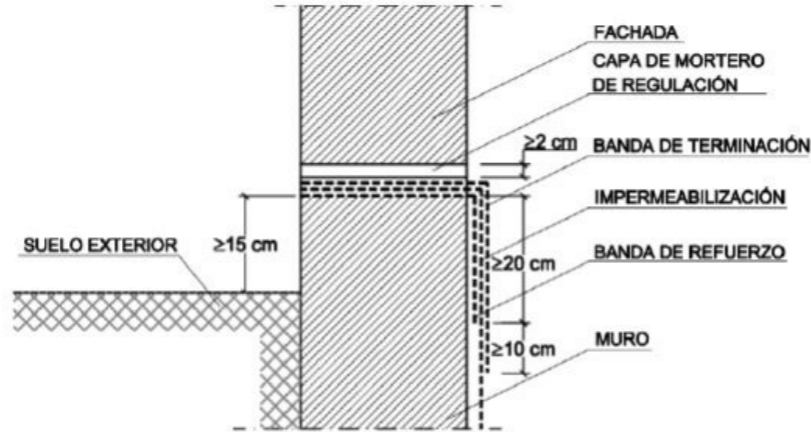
Ejemplo de encuentro de un muro impermeabilizado por el interior con lámina con una fachada
